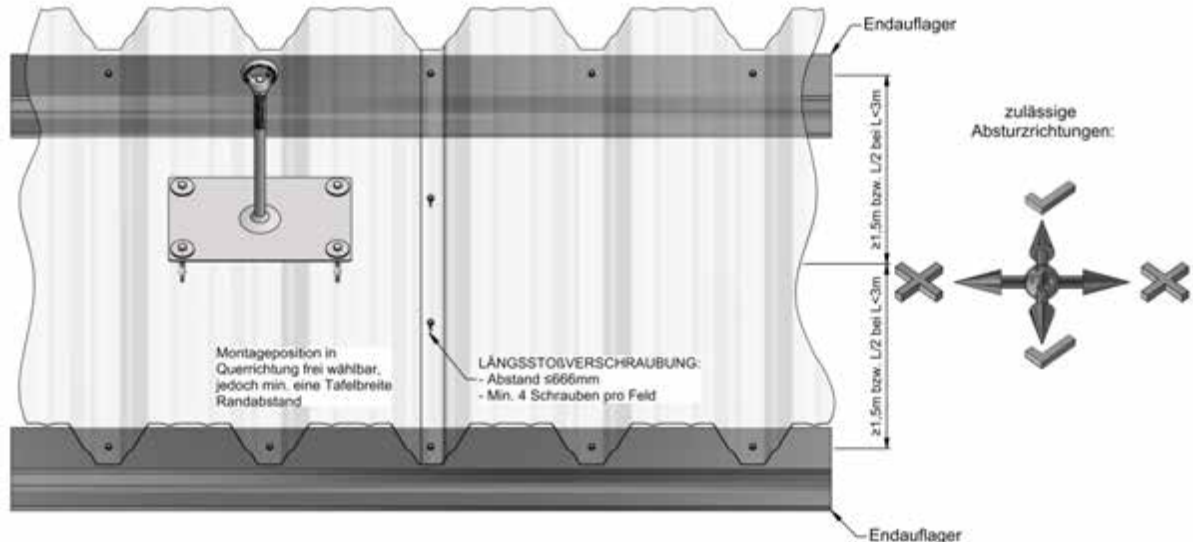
Montagevorgaben auf Trapezprofil (Positivlage) bei Absturzrichtung in Trapezprofilspannrichtung
